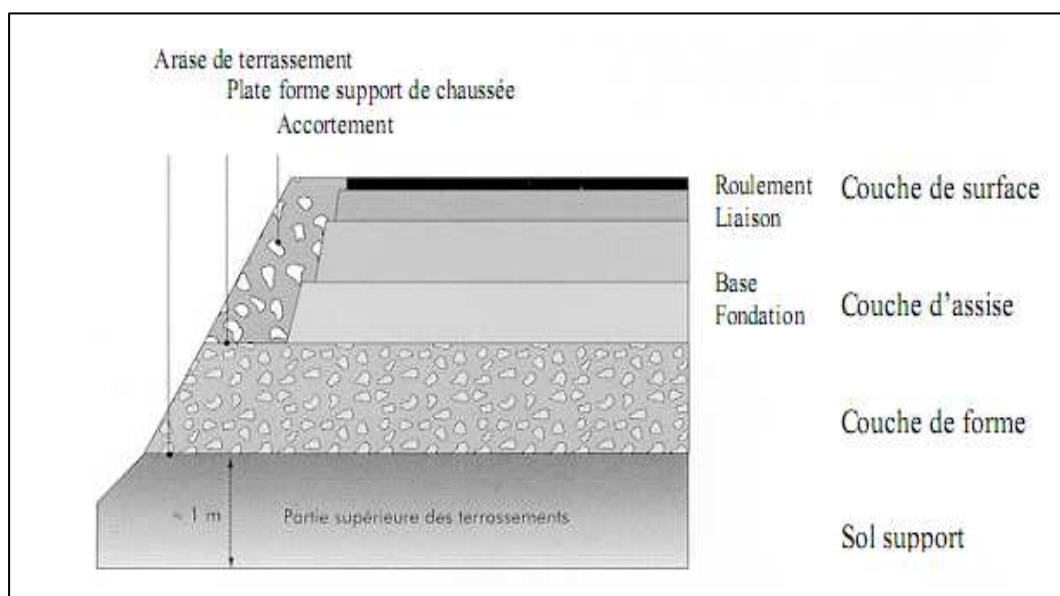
Schéma d'une coupe de chaussée [Set 1994].
